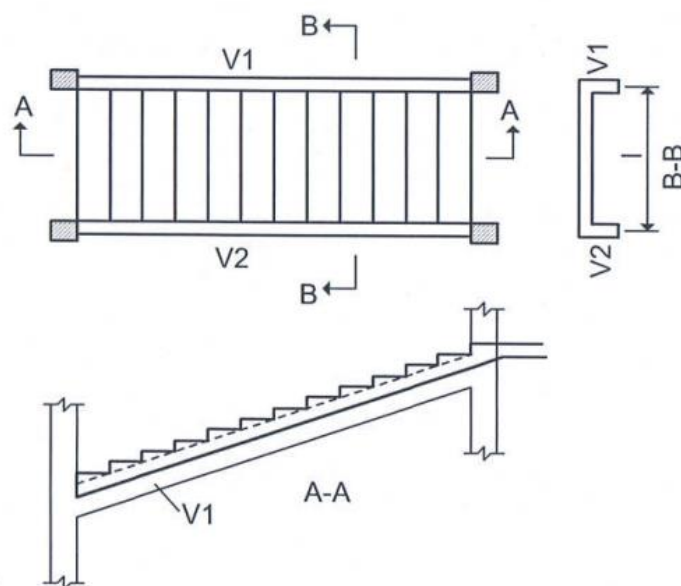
Escada armada transversalmente, apoiada em vigas laterais
